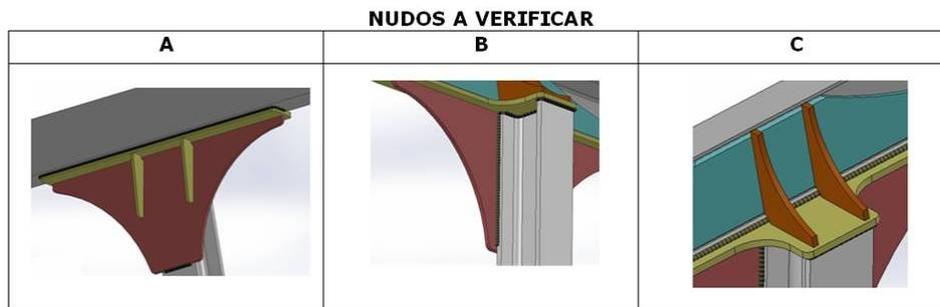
Soldadura entre el piso superior y el conjunto y entre el conjunto y el montante.
